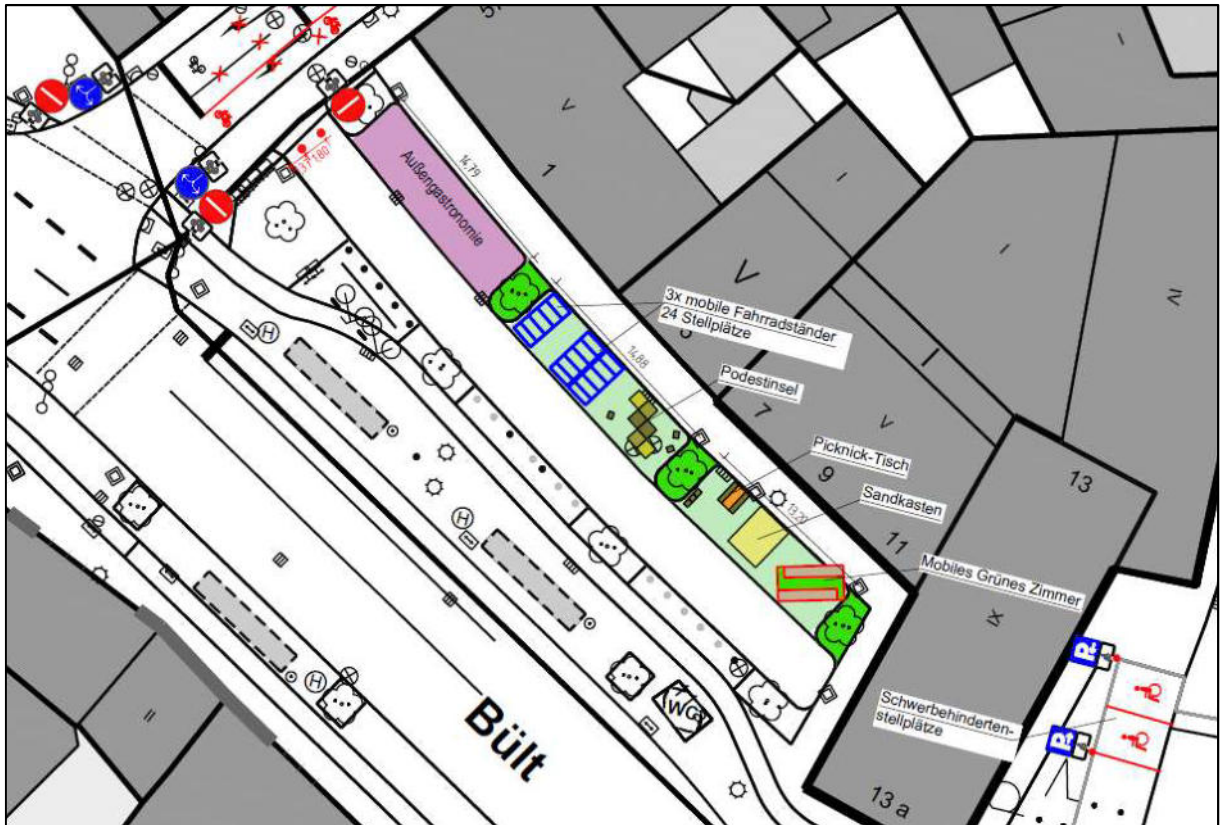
Lageplan zum Teilbereich Bült im Verkehrsversuch (Stadt Münster)
